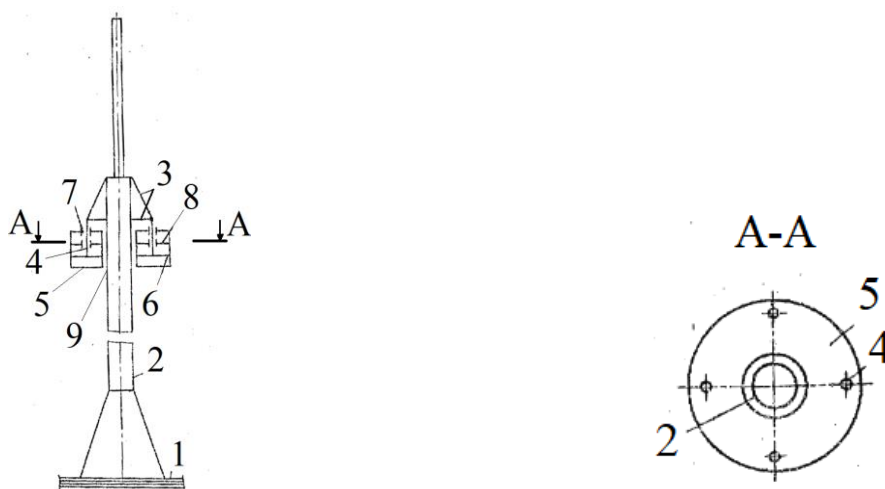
Башенное сооружение: 1 – опорная часть; 2 – ствол; 3 – консольные выступы; 4 – тяги; 5 – обстройка; 6 – перекрытия; 7 – зазор между тягами и перекрытиями; 8 – перекрытие; 9 – зазор между обстройкой и стволом
